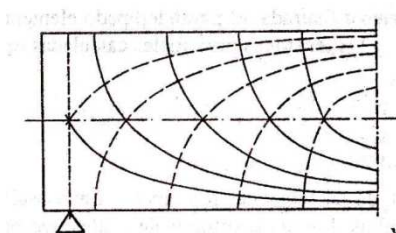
Viga no fisurada.
